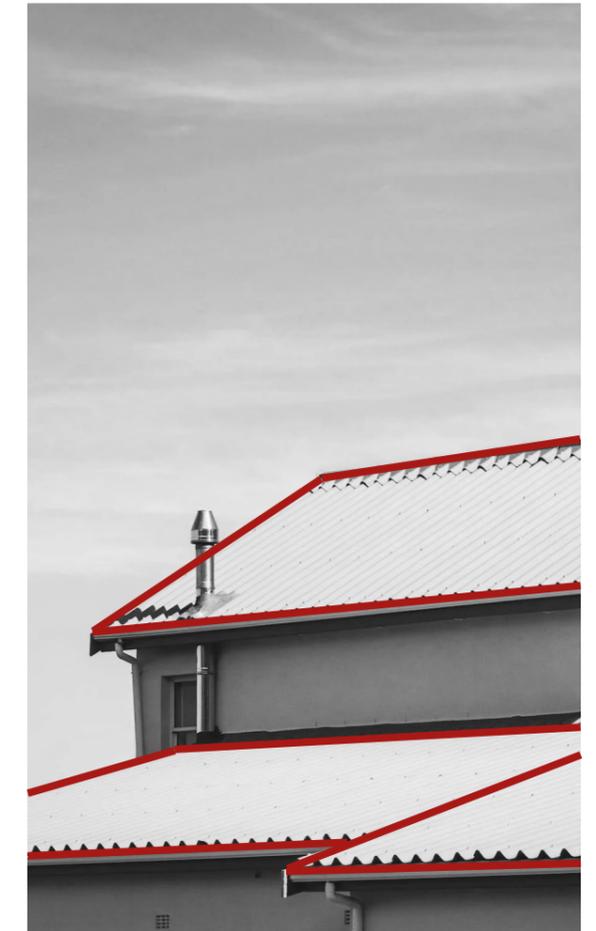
Cubierta de elementos prefabricados . Fuente: (Myburgh Roux, s. f.)
